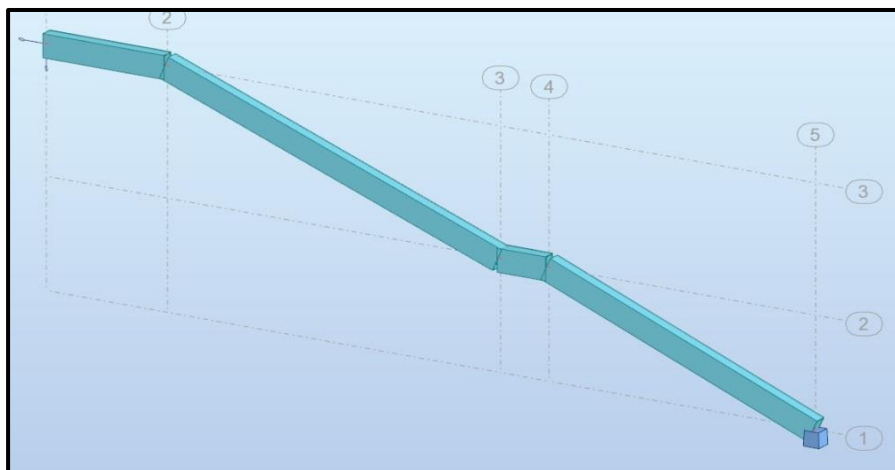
Poutre non courbée considérée pour la Coupe 9-9 des escaliers métalliques
